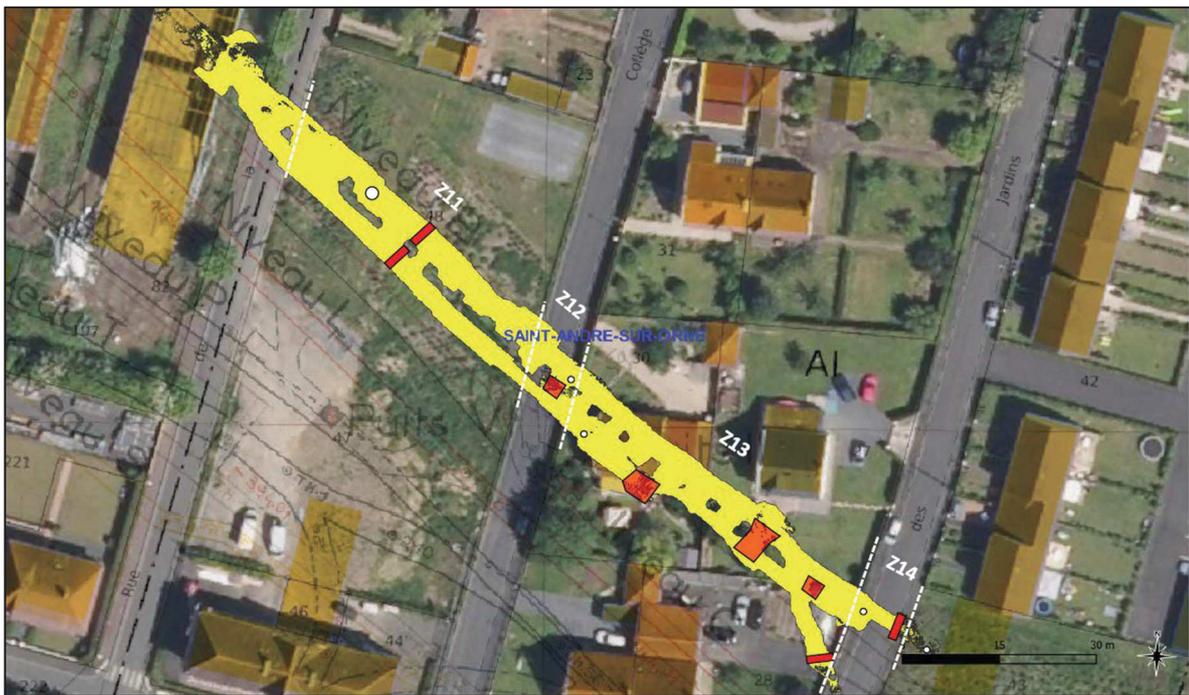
Vue en plan de la galerie de niveau B au droit des zones 12 à 14.
